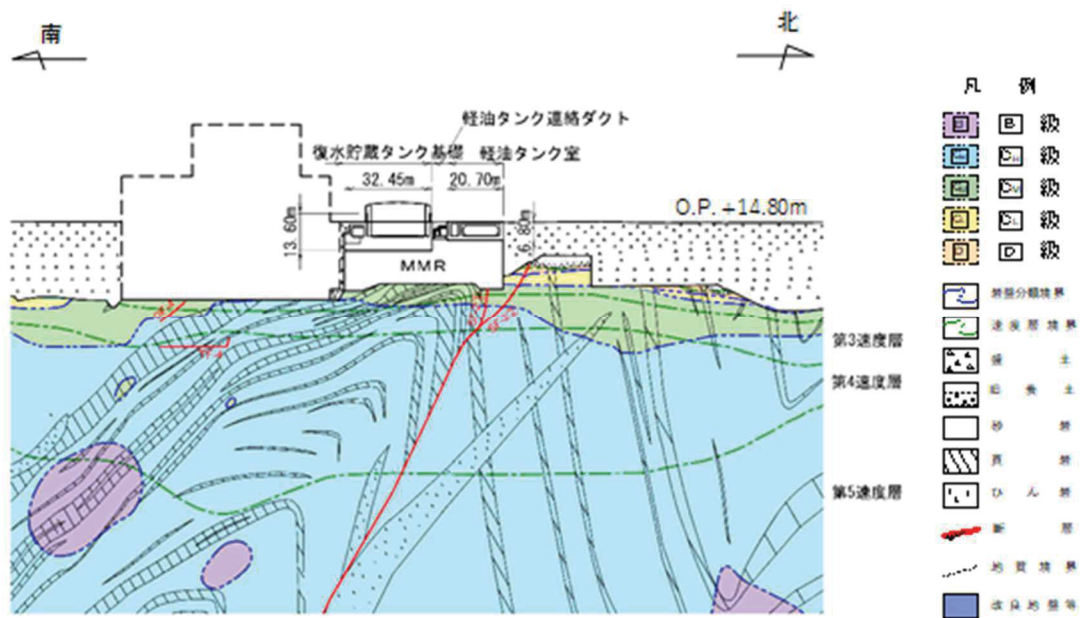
軽油タンク室，復水貯蔵タンク基礎の地質断面図 (⑮-⑮断面)
